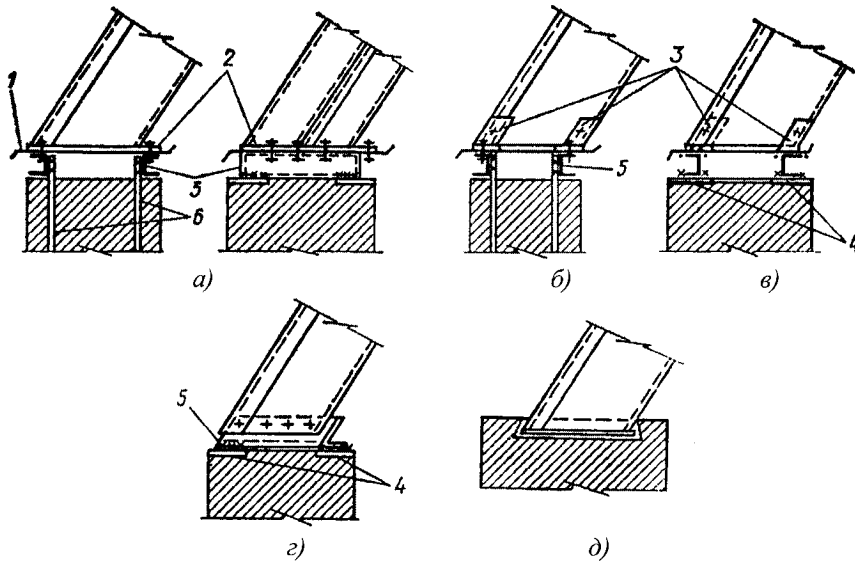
Конструктивні рішення опорних вузлів БСБ: а – на фланцях; б, в – на спеціальних кріпильних деталях; г – з фундаментною рамою спеціальної конструкції; д – з безпосереднім закріпленням опорних елементів у фундаменті: 1 – водовідвідний лист; 2 – фланці; 3 – кріпильні деталі; 4 – закладні деталі; 5 – фундаментна рама, 6 – анкерні болти
